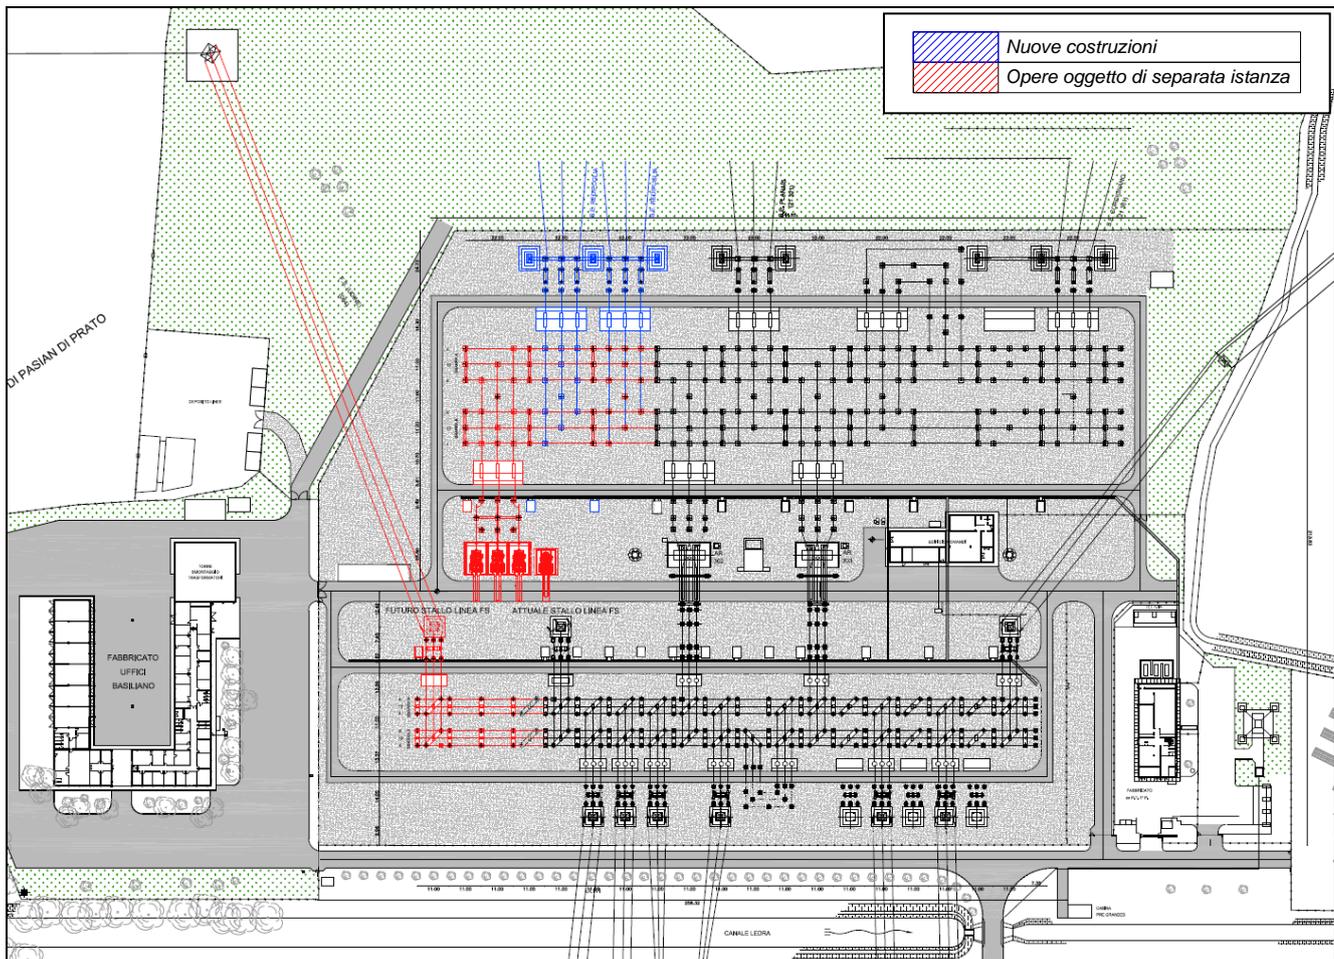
Planimetria di stazione - Interventi di ampliamento
